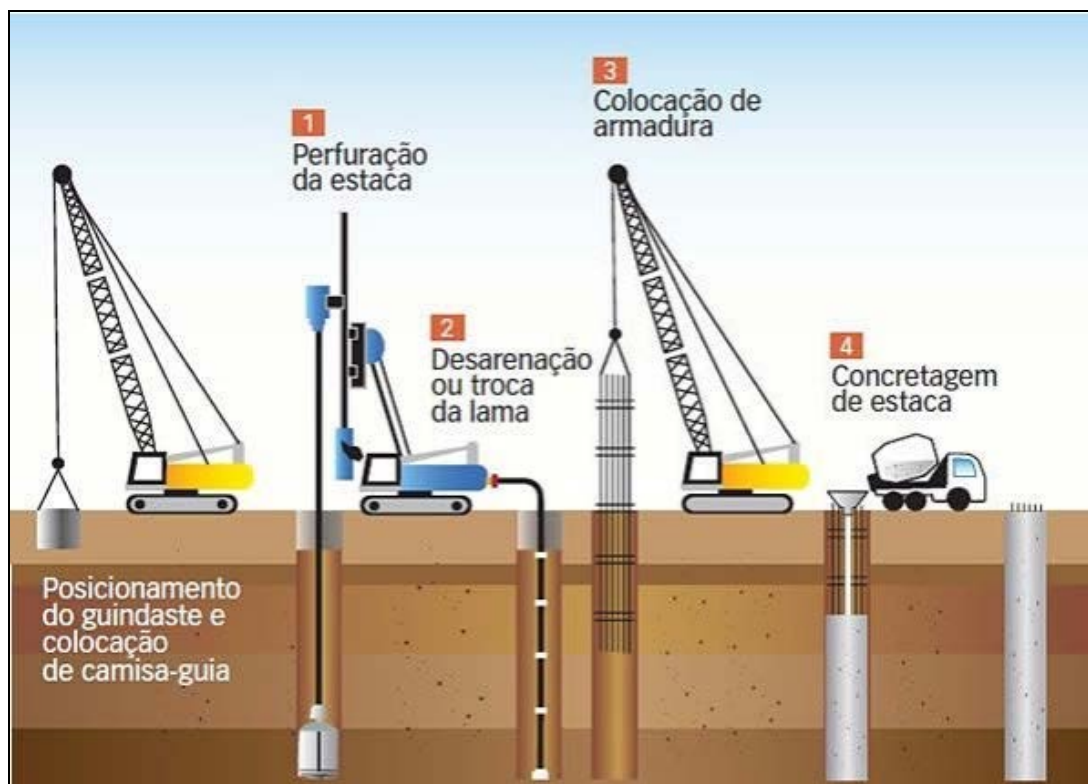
Processo Construtivo Estaca Escavada.
